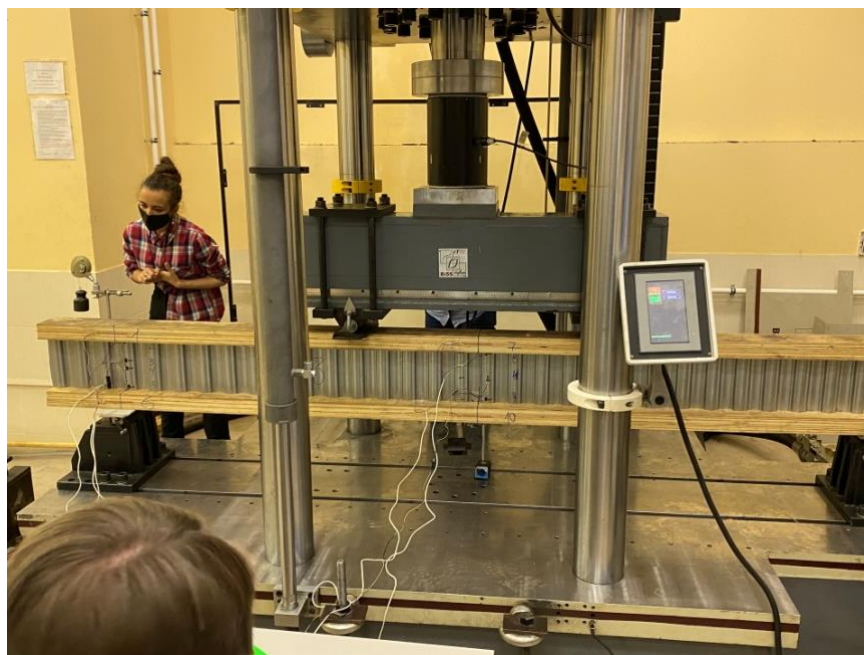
Испытание образца №3 сосредоточенной нагрузкой
